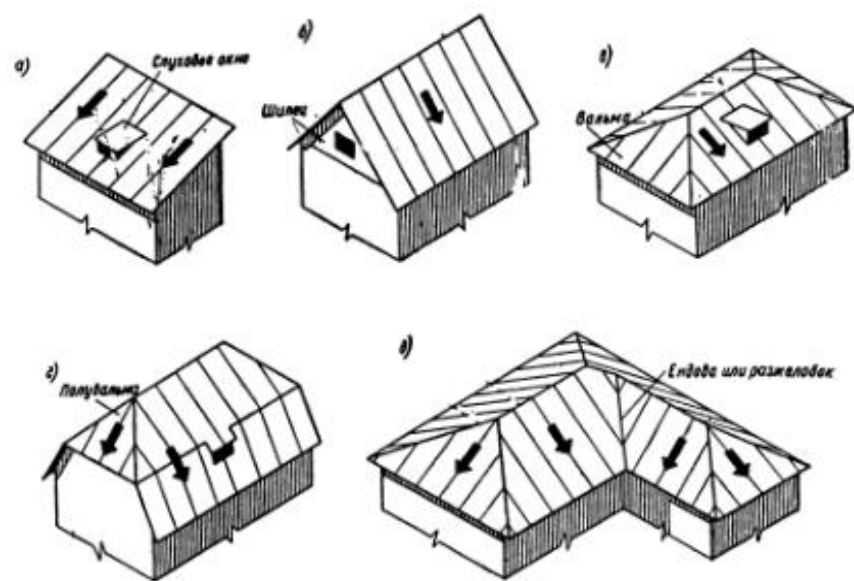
Основные типы и элементы скатных крыш: а – односкатная; б – двухскатная; в – четырехскатная; г – полувальмовая; д – четырехскатная на угловом здании
